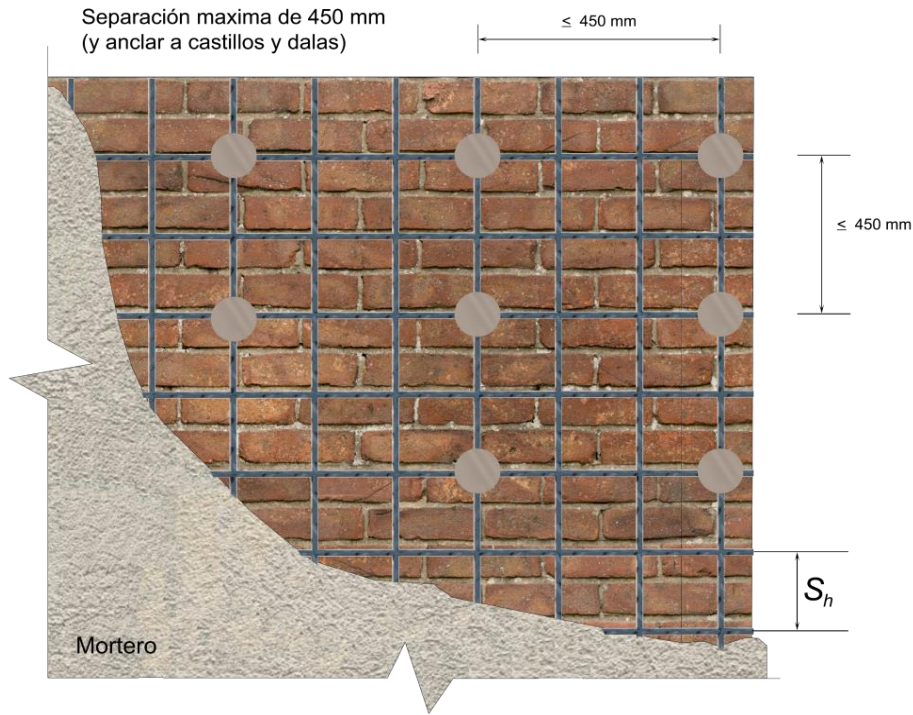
Detalles para la colocación de malla de alambre soldado sobre muros de mampostería.
